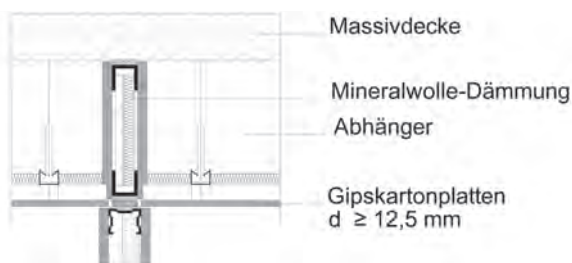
Abgehängte Unterdecke mit Plattenschott (Quelle: Baradiy)
